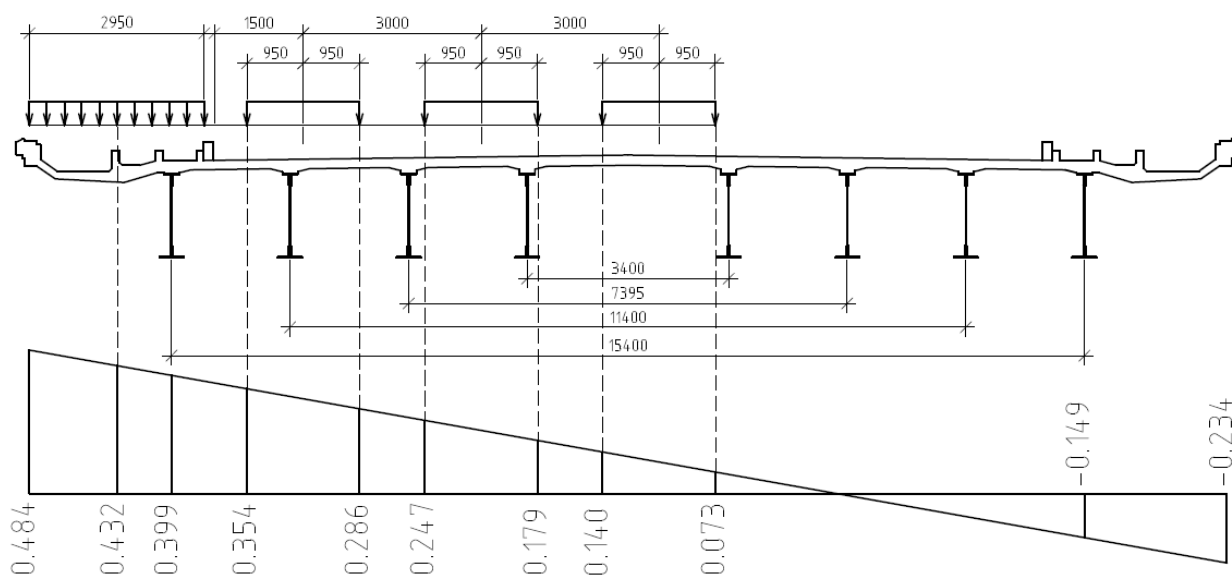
Схема определения КПУ для временной подвижной нагрузки А-15 и пешеходной нагрузки на левом тротуаре с линией влияния давления на крайнюю балку Б1
